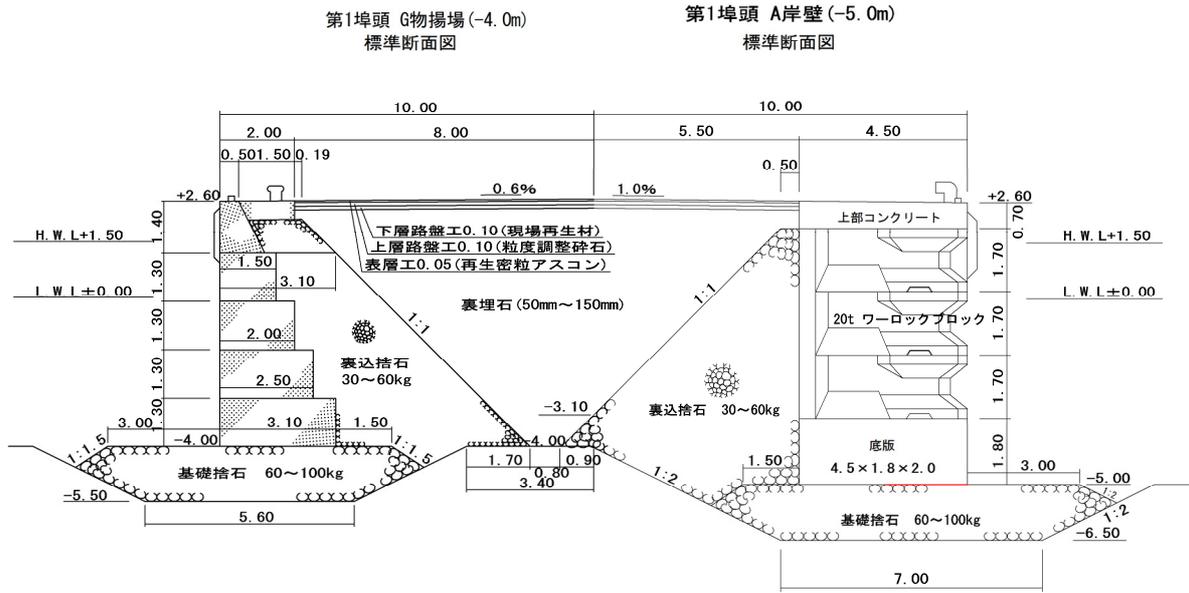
268 No.27 大洗港区_第1埠頭 G物揚場 (-4.0m) (水産ふ頭地区) の断面図 (被災前)
